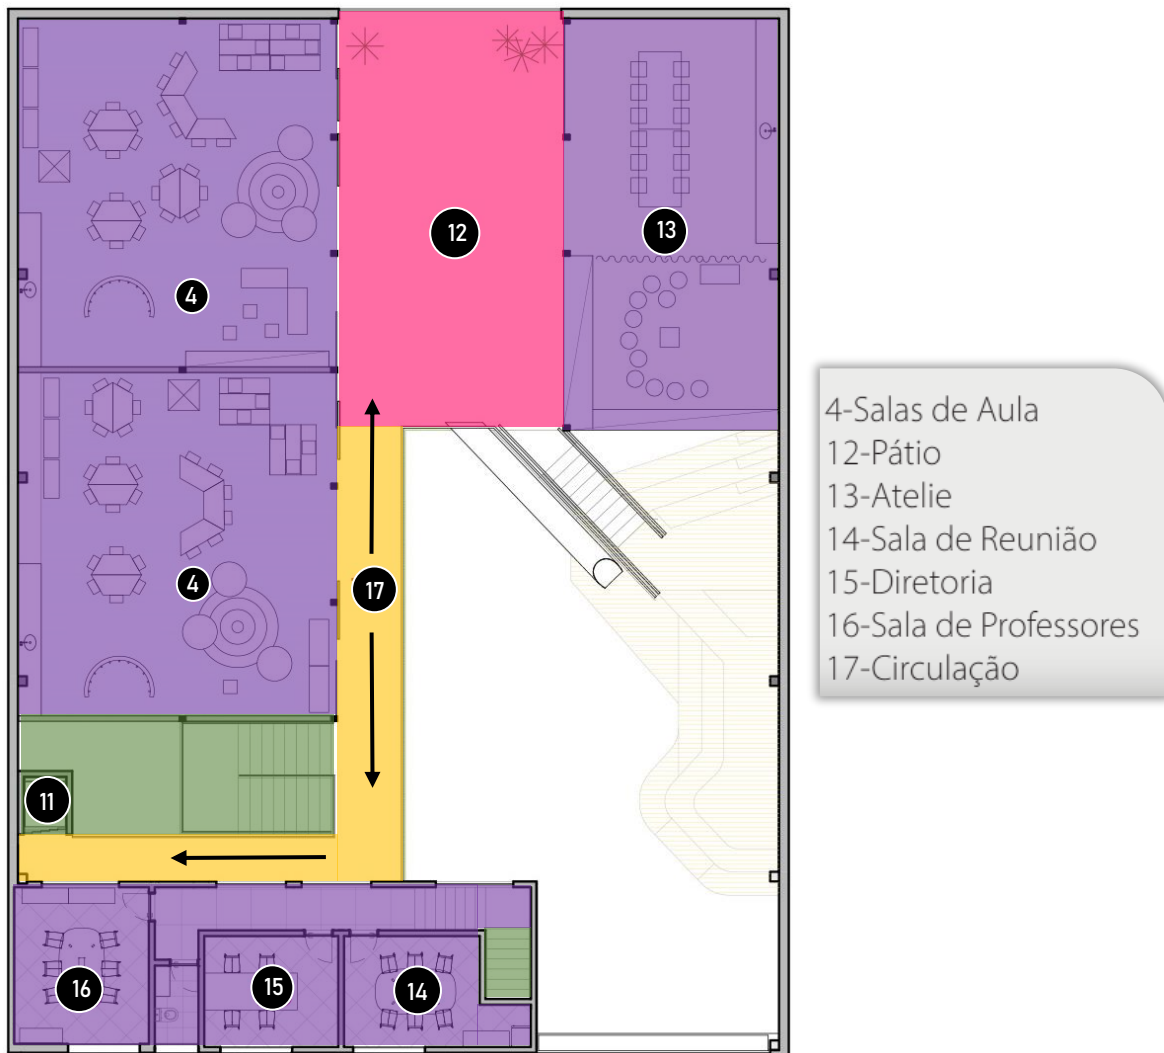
PLANTA BAIXA PAV. TÉRREO
